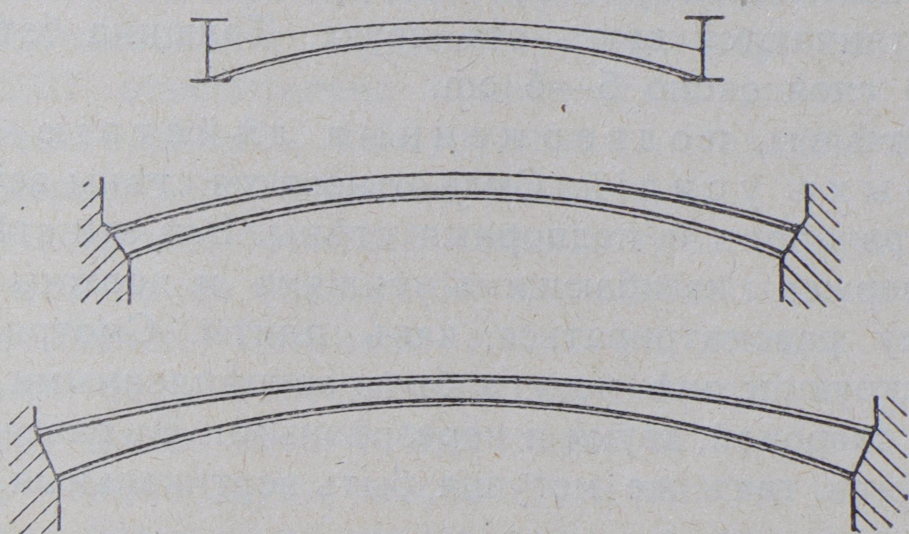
Форма желѣзо-бетонныхъ сводовъ.
